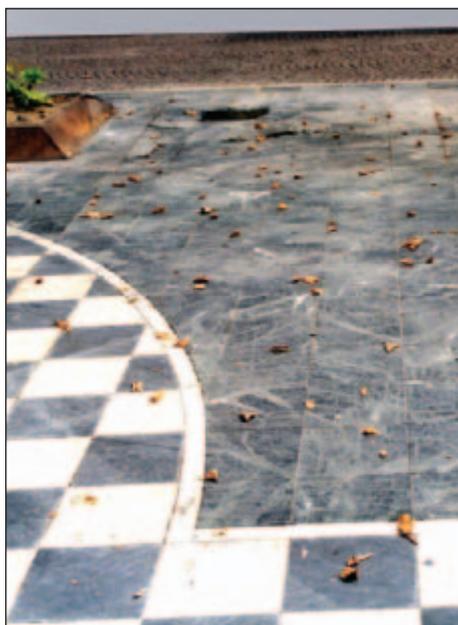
Esempio di pavimentazione (Reggio Emilia)
